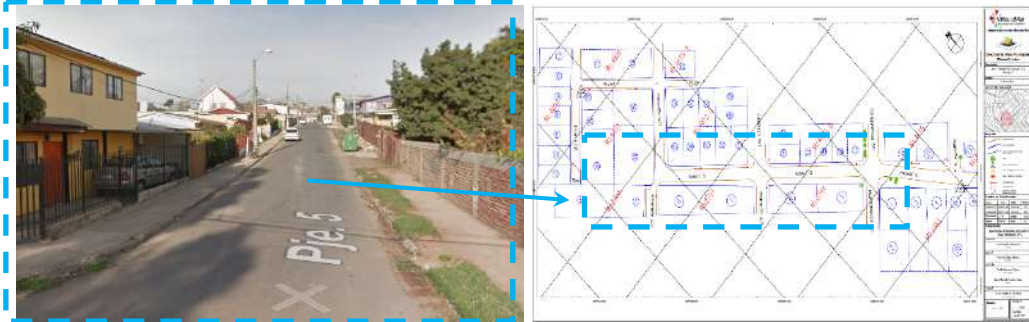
Levantamiento Topográfico del Pasaje 5, Sector Achupallas.
